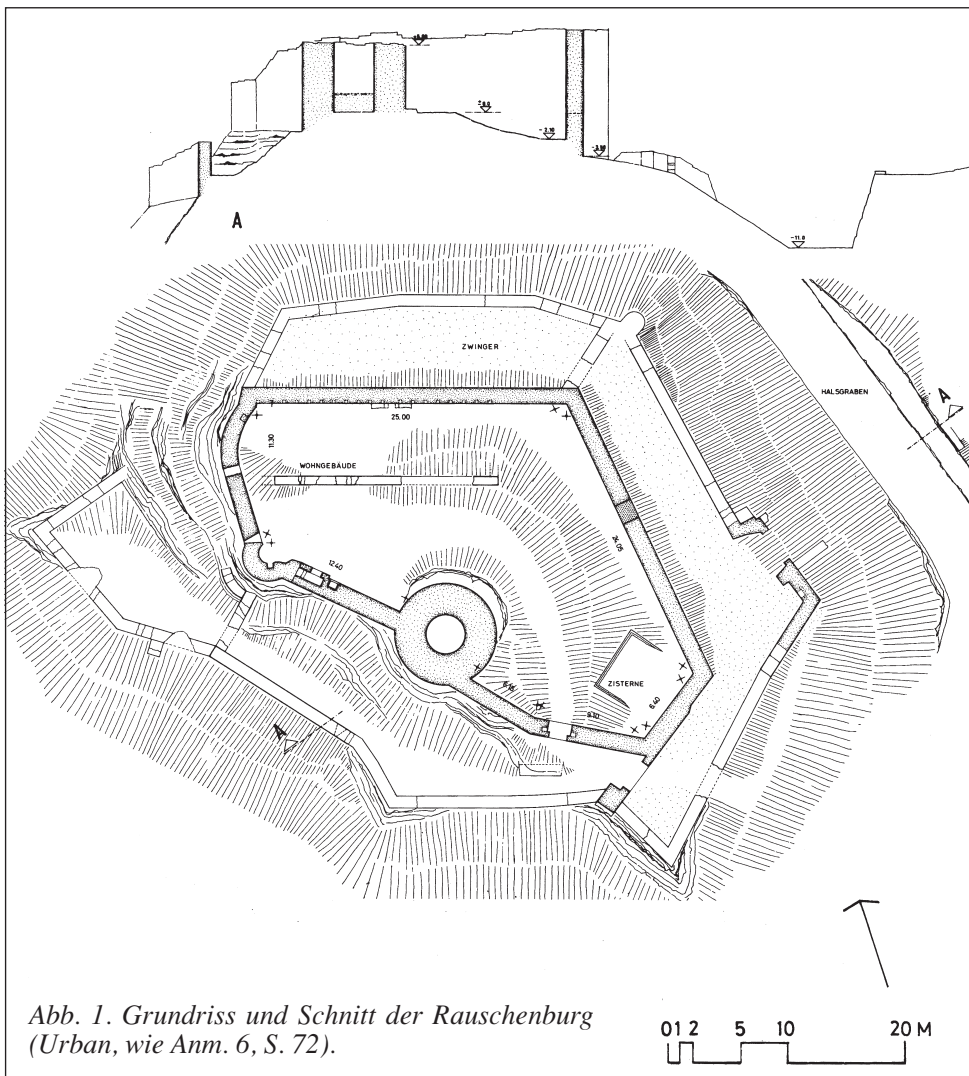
Grundriss und Schnitt der Rauschenburg (Urban, wie Anm. 6, S. 72).
